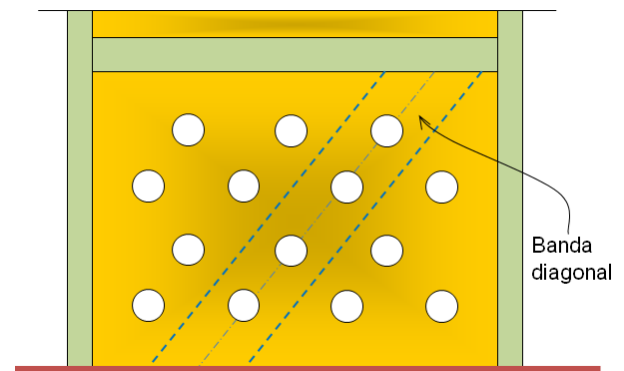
Muro de corte con placas de acero y perforaciones circulares.
